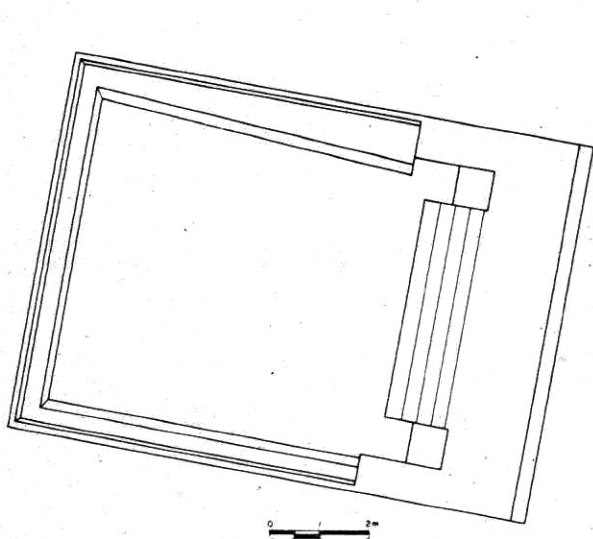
Planta Edificio 46. Levantó: Alejandro Arenas Villalón
